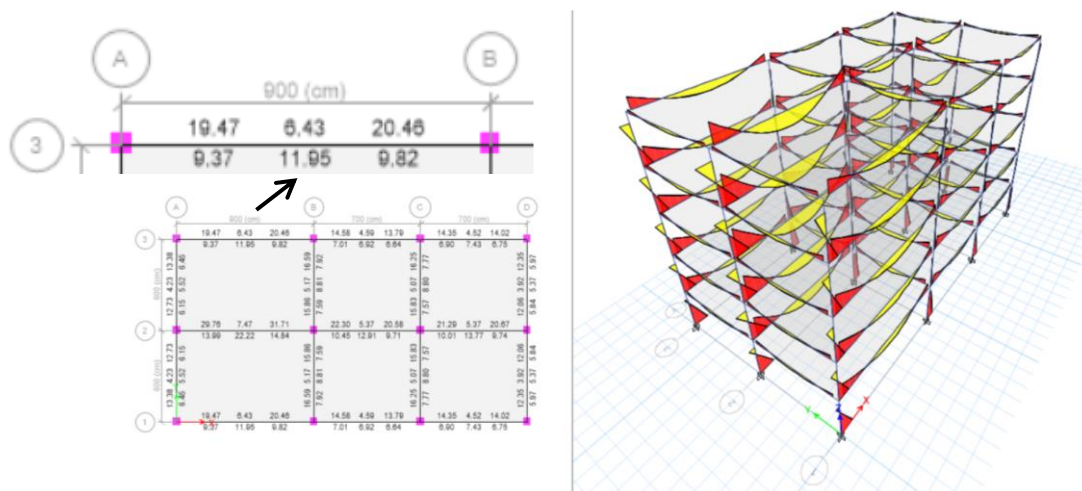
ETABS Área de acero de refuerzo en vigas del edificio de hormigón tradicional
